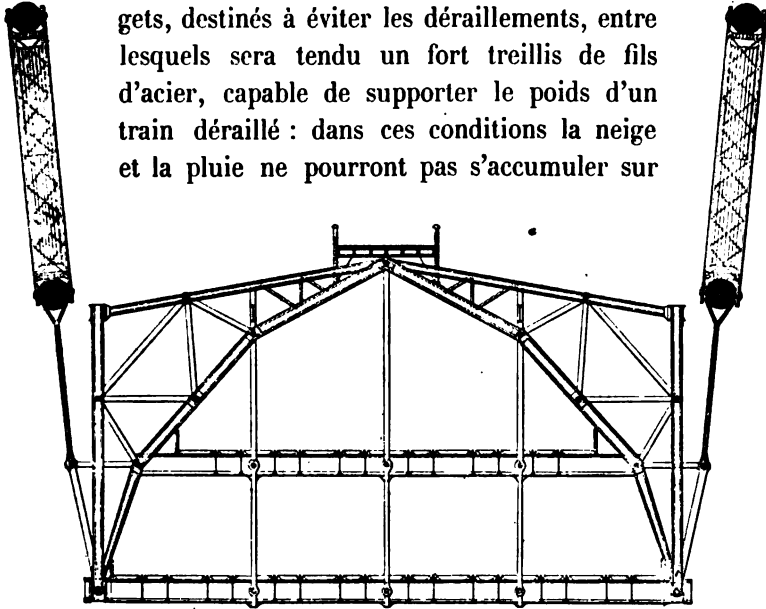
Coupe transversale du Pont sur l'Hudson.
